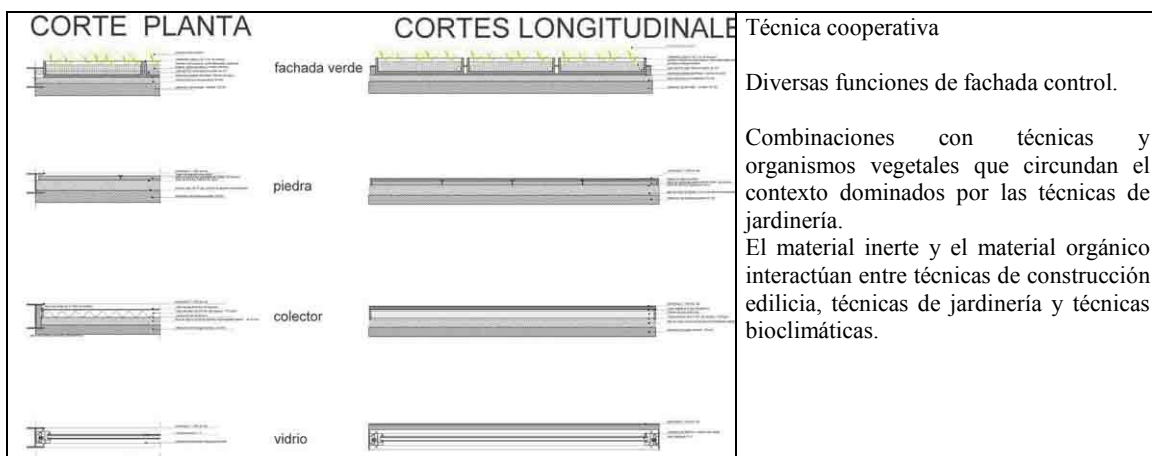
detalles constructivos de elementos constitutivos de la fachada multifunción.
